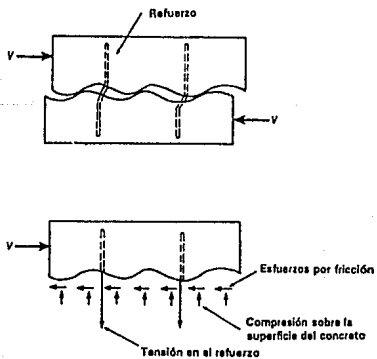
Hipótesis del cortante por fricción (Ref. 3)
